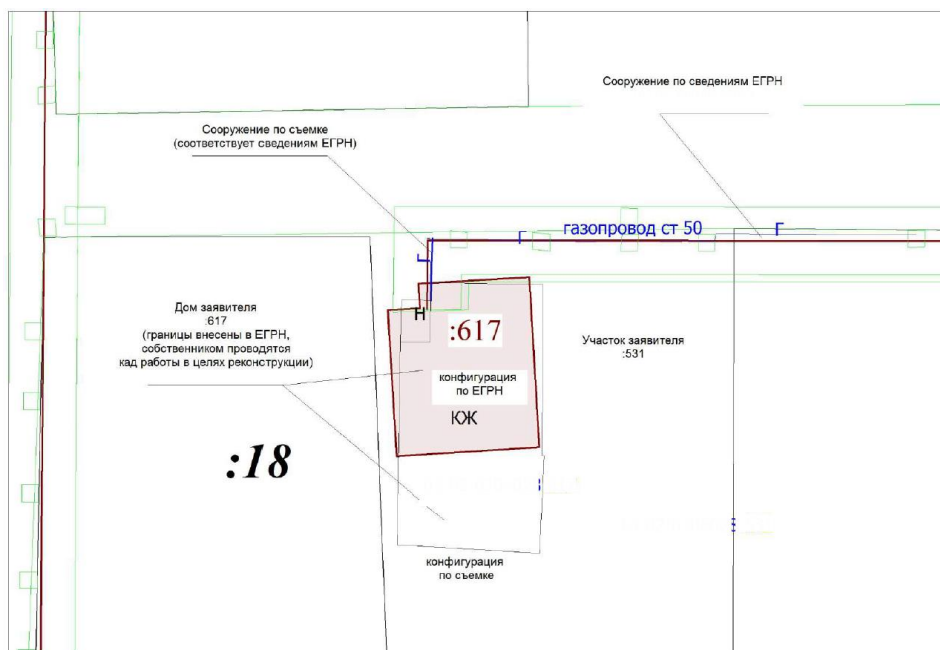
Схема пересечения границ объекта с границами охранной зоны газопровода
